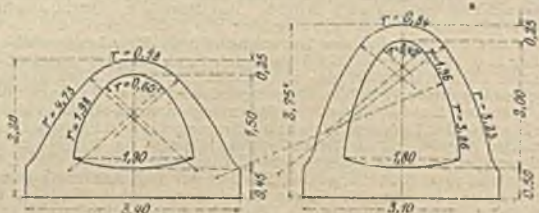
Gewölbte Durchlässe in Beton, für Hauptbahn.
